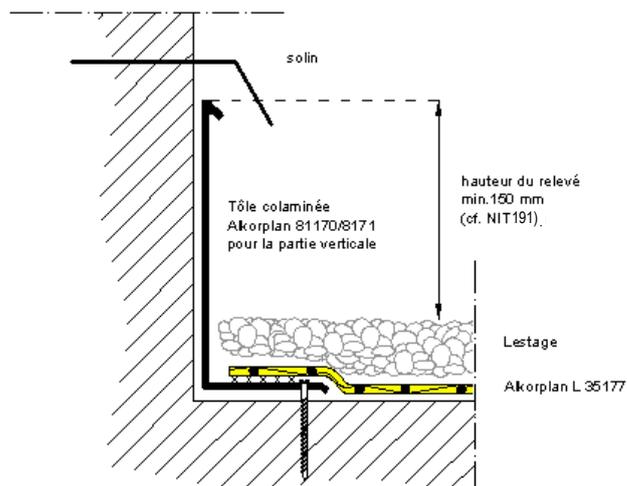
Exemple d'une fixation en rive dans le cas de l'Alkorplan® L de 1,2 mm d'épaisseur – fixation linéaire (tôle colaminée Alkorplan® 81170)
